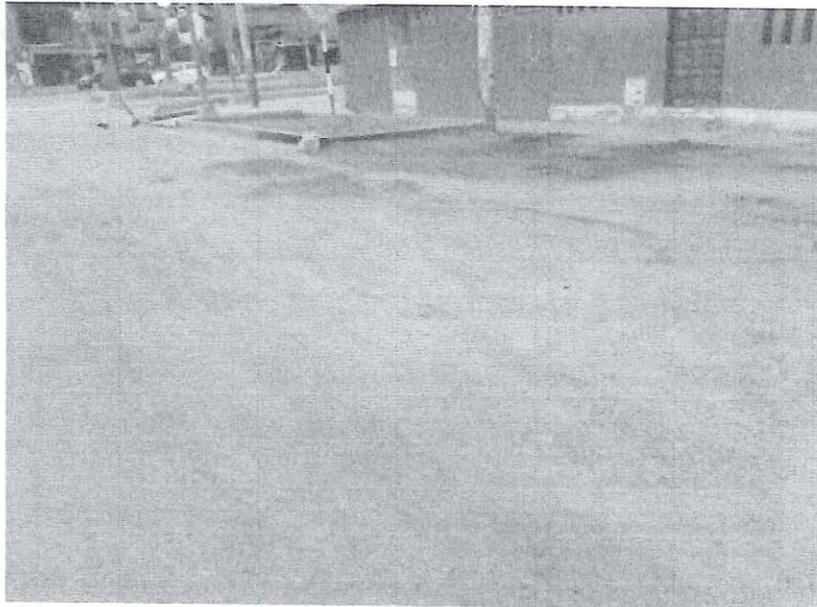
SE APRECIA GRIETAS Y FISURAS ENTRE LA AV. JOSE GABRIEL CONDORCANQUI - COMPLEJO
